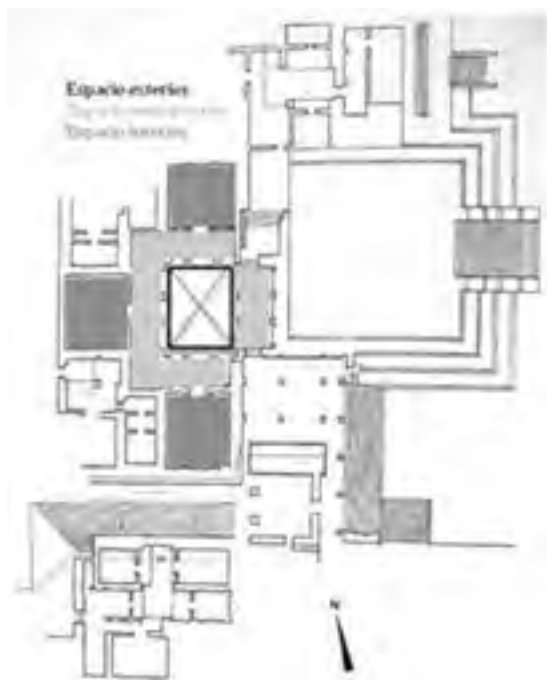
Planta arquitectónica del Palacio del Quetzalpapálotl en Teotihuacan. Fuente: elaboración propia.
